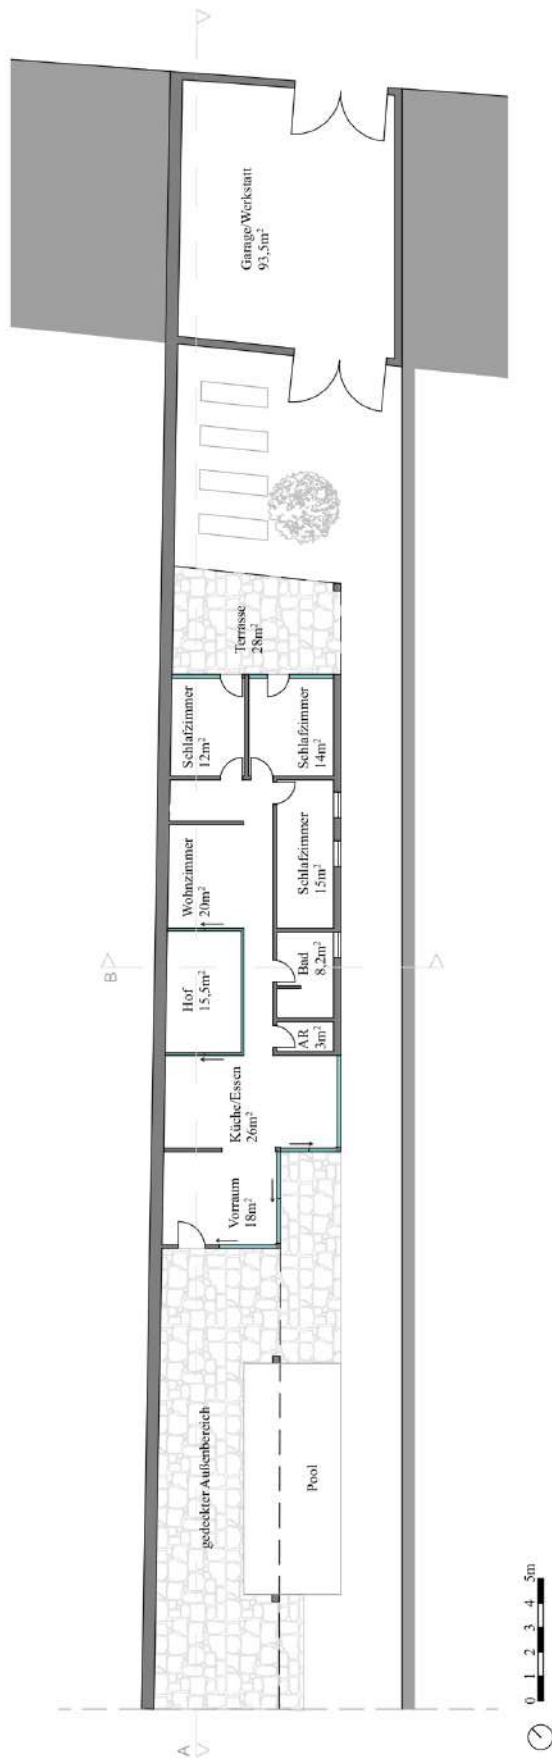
Grundriss Neubau, Möblierung und Gartengestaltung.
